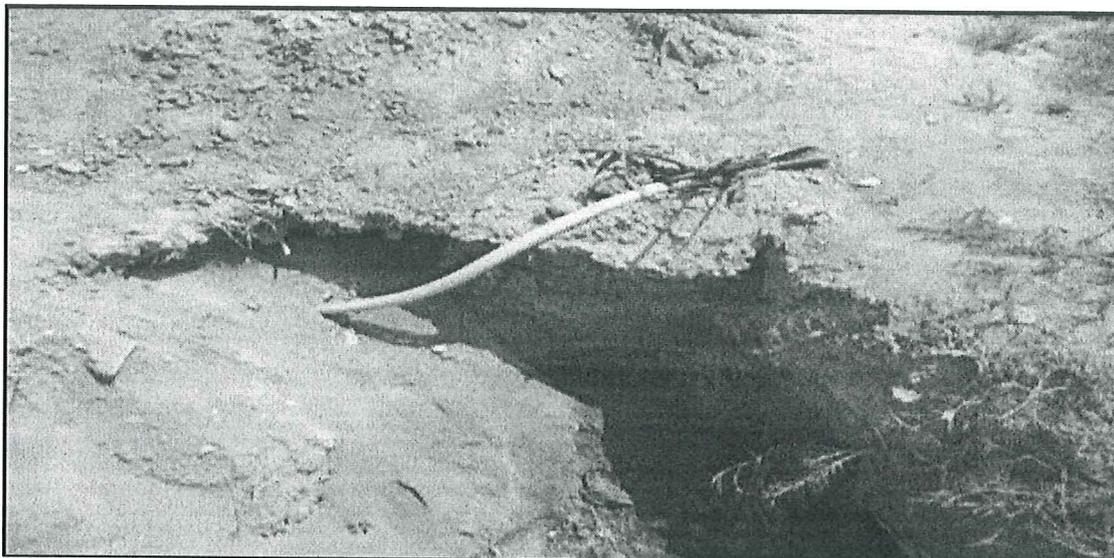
Conductor NKY Fisurado (Alimentador de la Subestación de la Facultad de Derecho)
